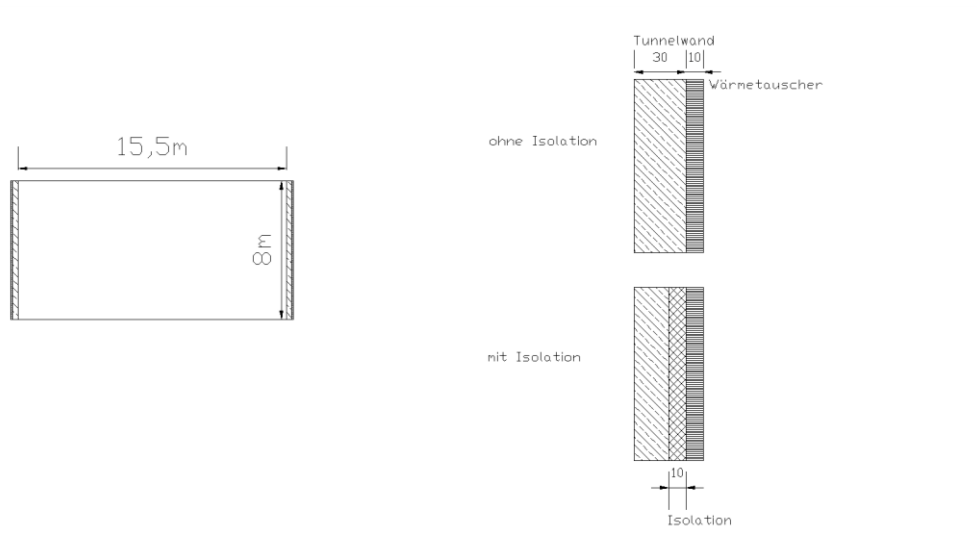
Rechteckiges Tunnelprofil: Flächenkollektorsystem mit zwei Wärmetauschern in beiden Tunnelwänden, links Querschnitt senkrecht zur Tunnelachse, rechts Vergrößerung Querschnitt durch Flächenkollektorsystem (Bemassung in cm)
